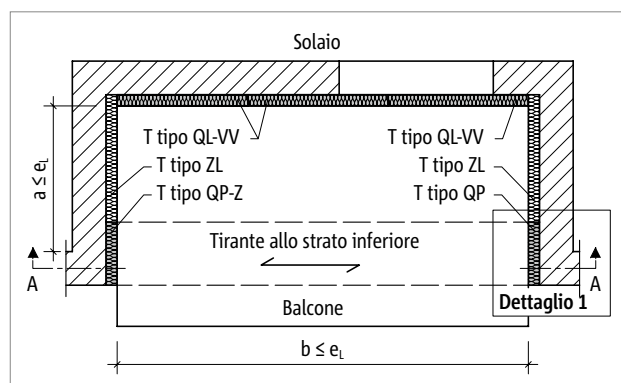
Schöck Isokorb® T tipo QP-Z, QP: pianta loggia
